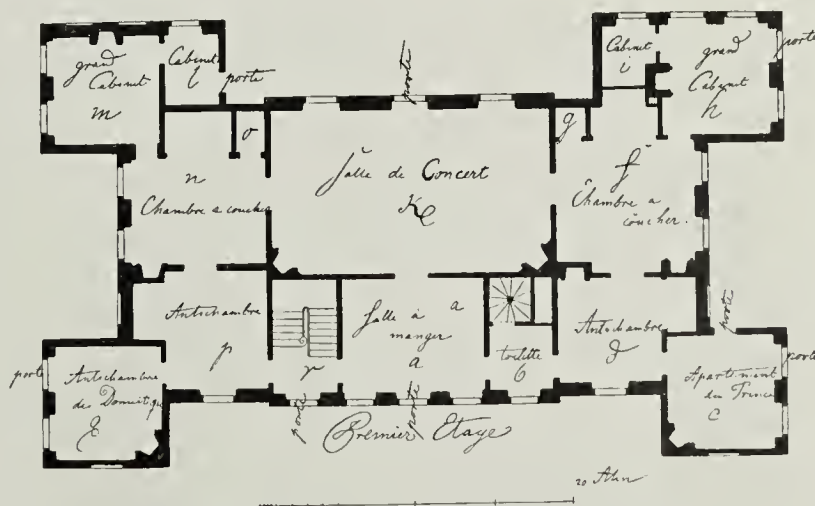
Grundplan af det nye Palais paa Frydenlund.
